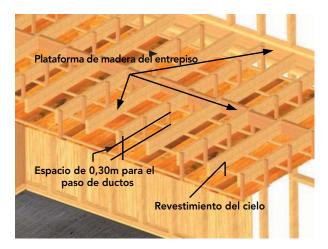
Cielo falso para el paso de ductos de alcantarillado.
